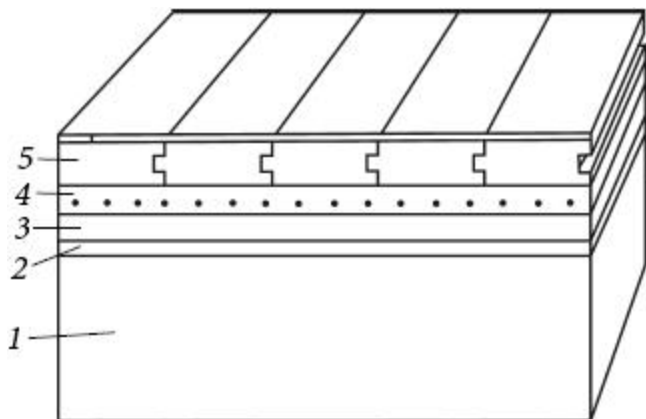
Оклеечная теплоизоляция по бетонному основанию: 1) бетонное перекрытие; 2) слой гидроизоляционной мастики; 3) утеплитель; 4) стяжка с армированием; 5) напольное покрытие
